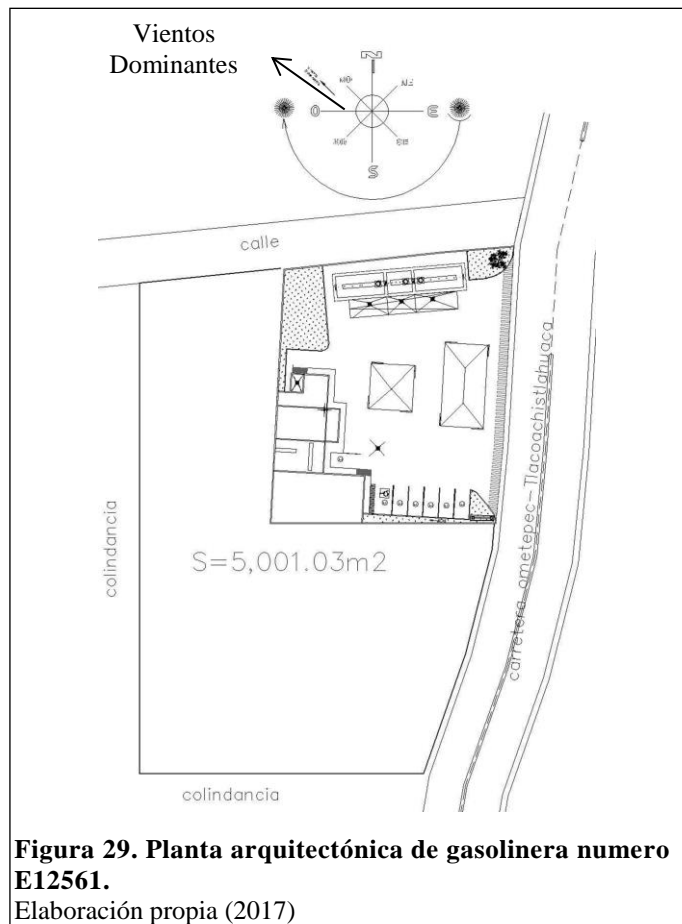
Planta arquitectónica de gasolinera numero E12561.
